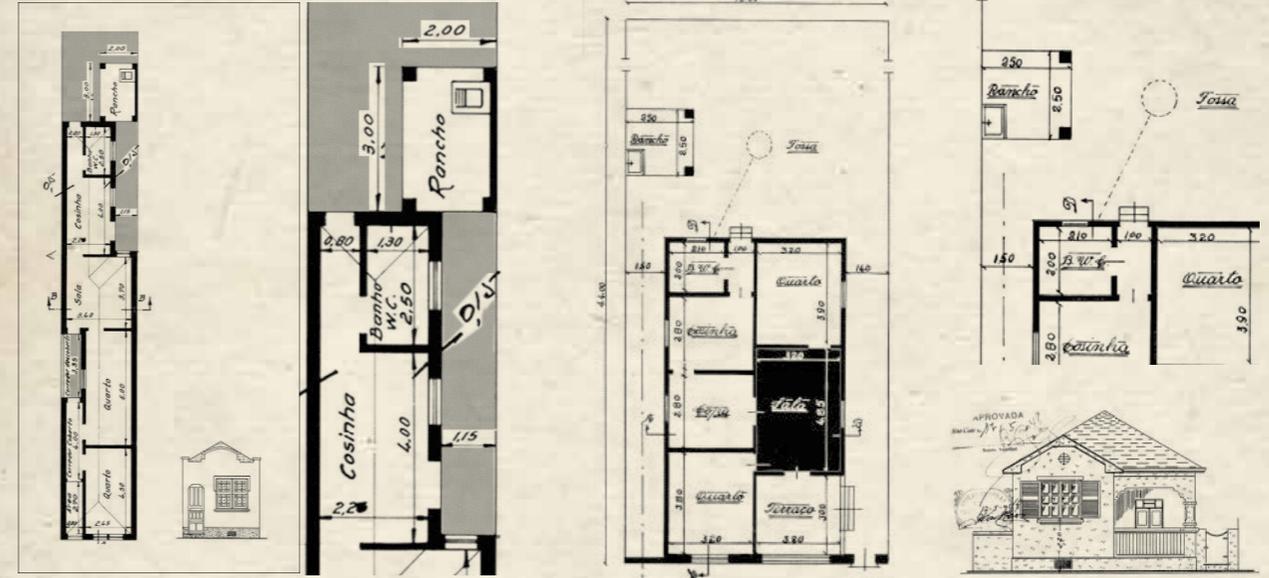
Plantas arquitetônicas e detalhe. No primeiro exemplo, no setor de serviços, na parte posterior da planta e vinculada à construção principal, o rancho para tanque era construção simplificada, sem paredes laterais, próximo ao quintal (utilizado para estender as roupas ao sol) e à cozinha (para economia dos encanamentos). No segundo exemplo, o rancho para tanque estava desvinculado da construção principal, em precária edificação anexa PC 19/52 e PC 209/48. (APH-RC)
